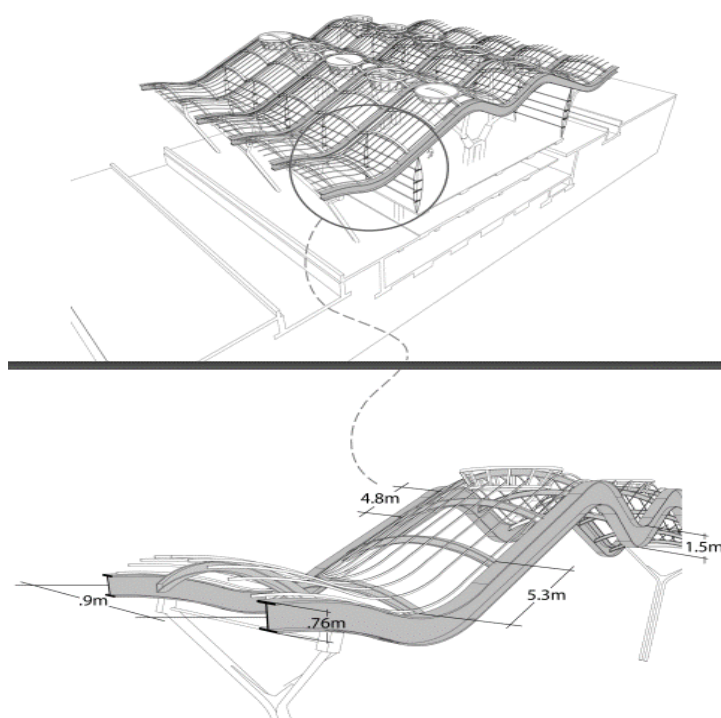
Detalle proyección de cubierta como estrategia bioclimática.
